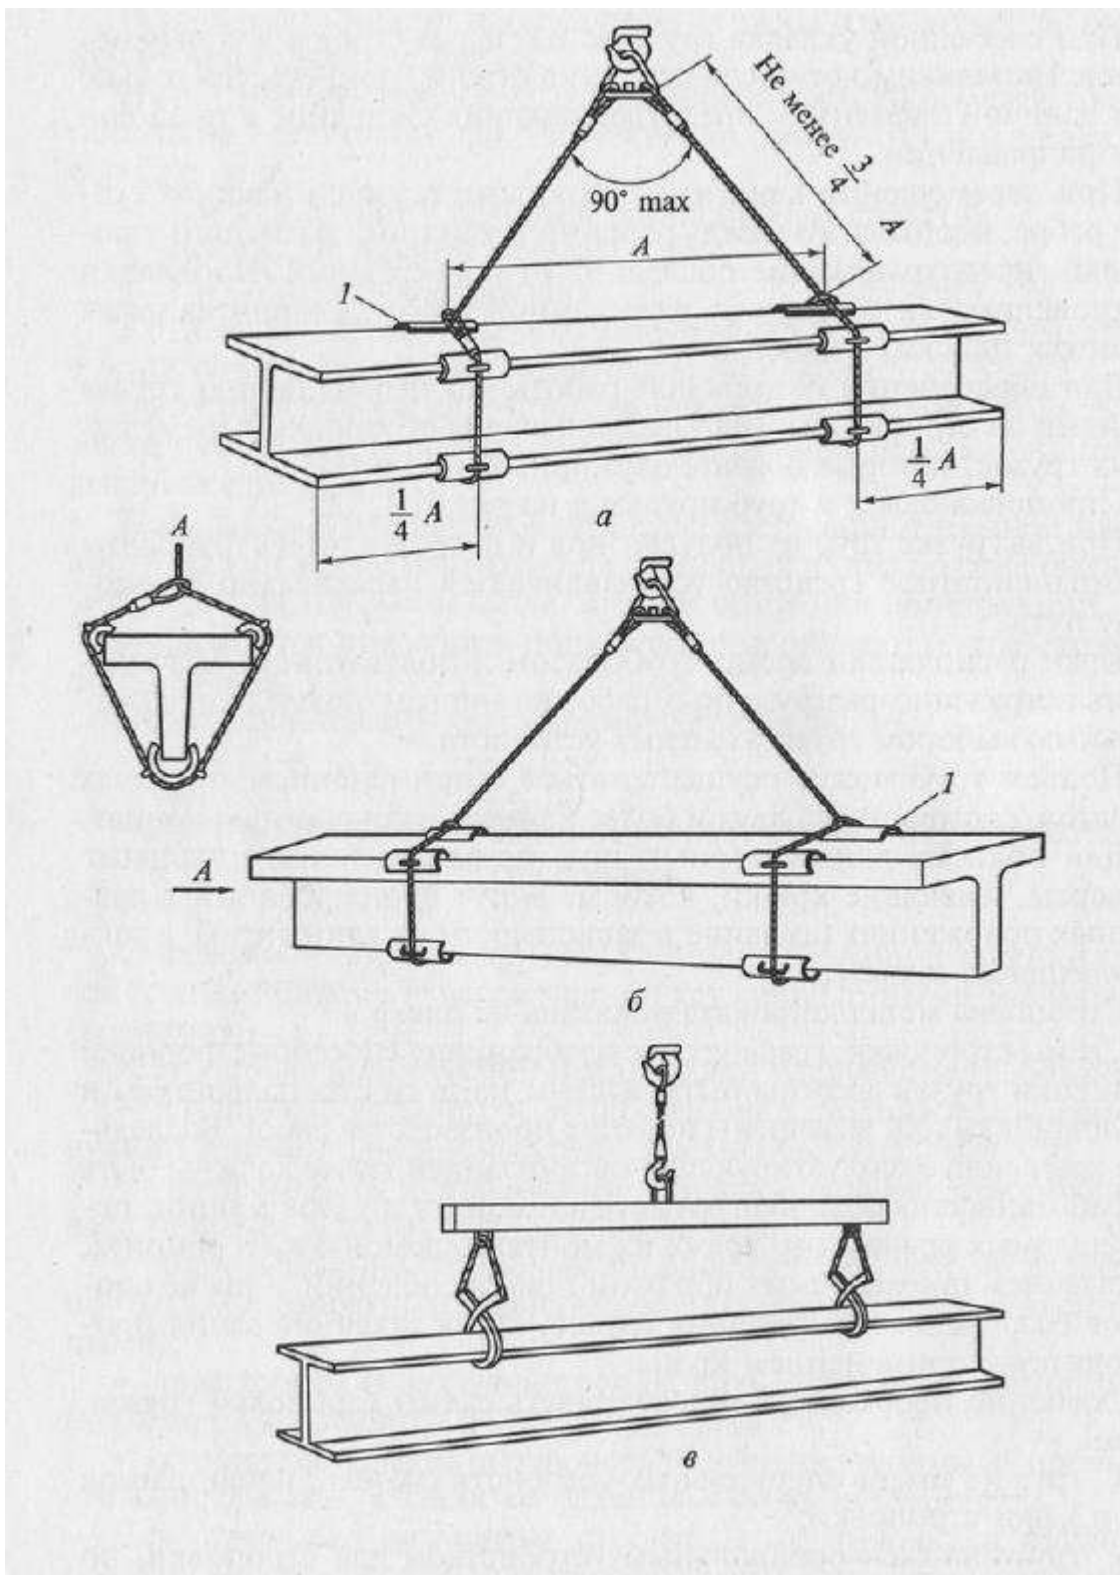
Строповка балок: а — металлической (в обхват); б — железобетонной (в обхват); в — металлической (траверсой с клещевыми захватами); 1 — подкладка.
